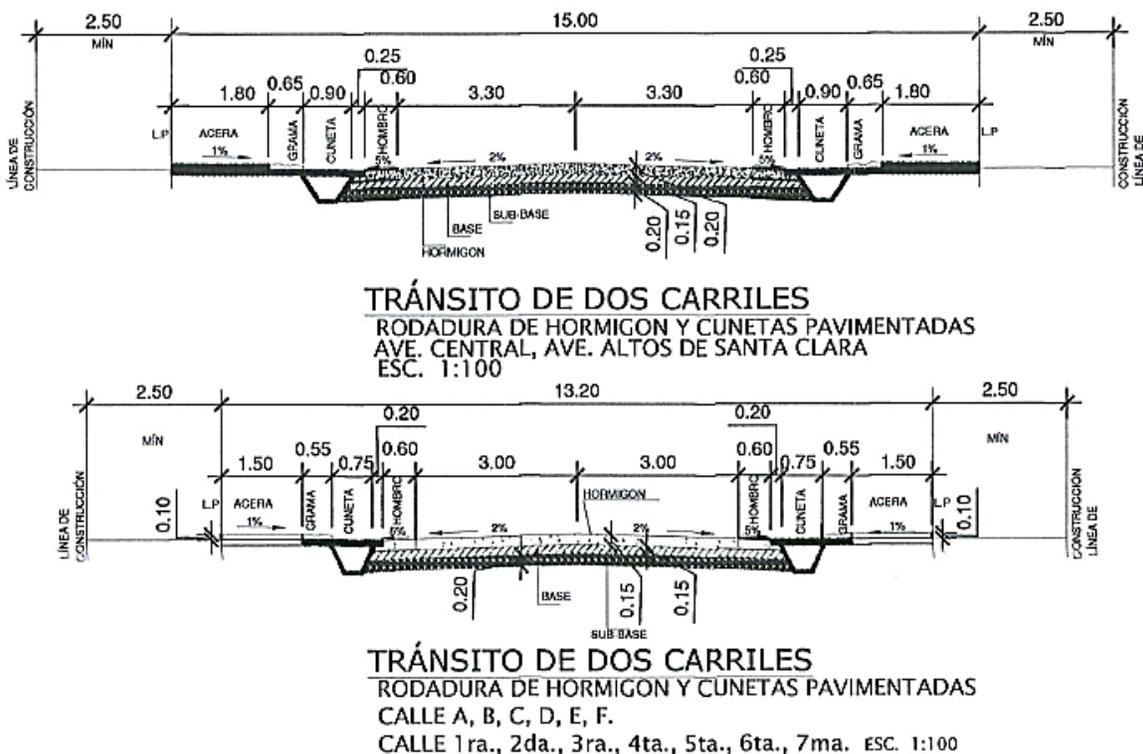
Detalle (sección). Ave. Central y Ave Altos de Santa Clara de 15.00m. Calle A, B, C, D, F y Calle 1era 2da, 3era 4ta, 5ta, 6ta, 7ma de 13.20 m. Fuente: Planos del proyecto.
